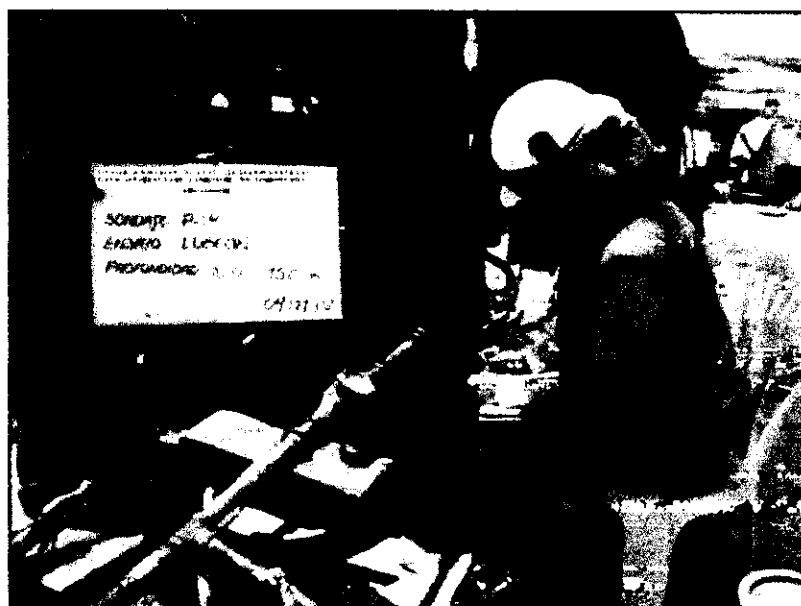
Sondaje P-14, Ensayo Lugeon N°01: 10.00 – 15.00 m
